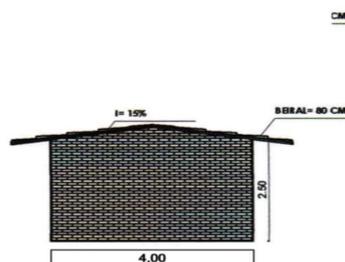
Estrutura de um módulo familiar estabilizado suficiente para a criação de 440 frangos de corte.
